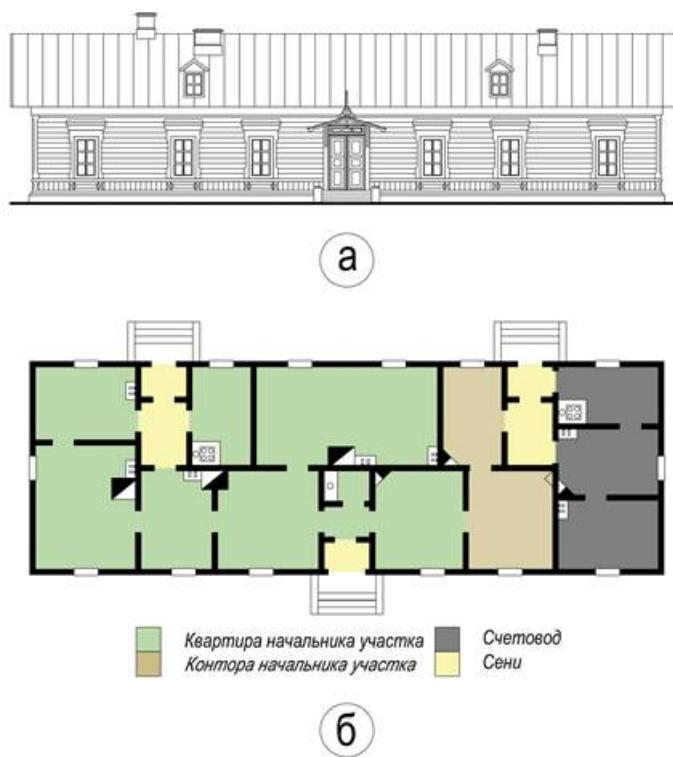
Жилой дом Южного участка на станции Никольское, тип А, №1 (дом начальника участка): а) фасад и б) план с зонированием помещений (реконструкция автора по чертежам [\[13, с. 50\]](#))
